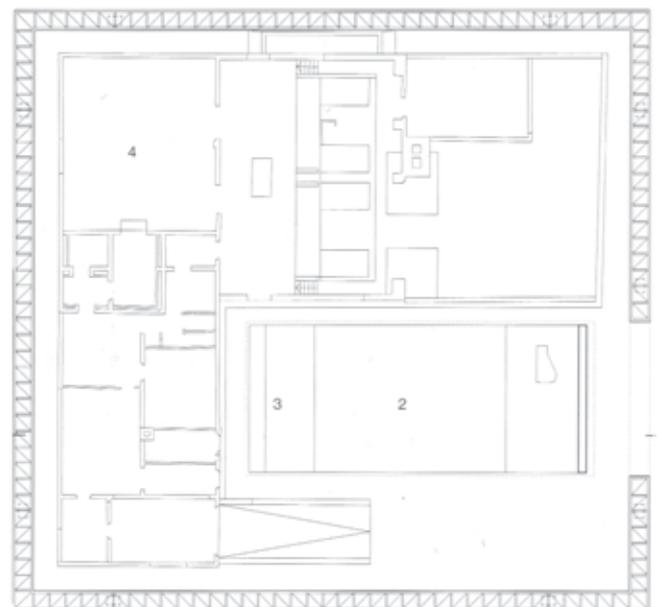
Grundriss Gedenkstätte, Sachsenhausen
